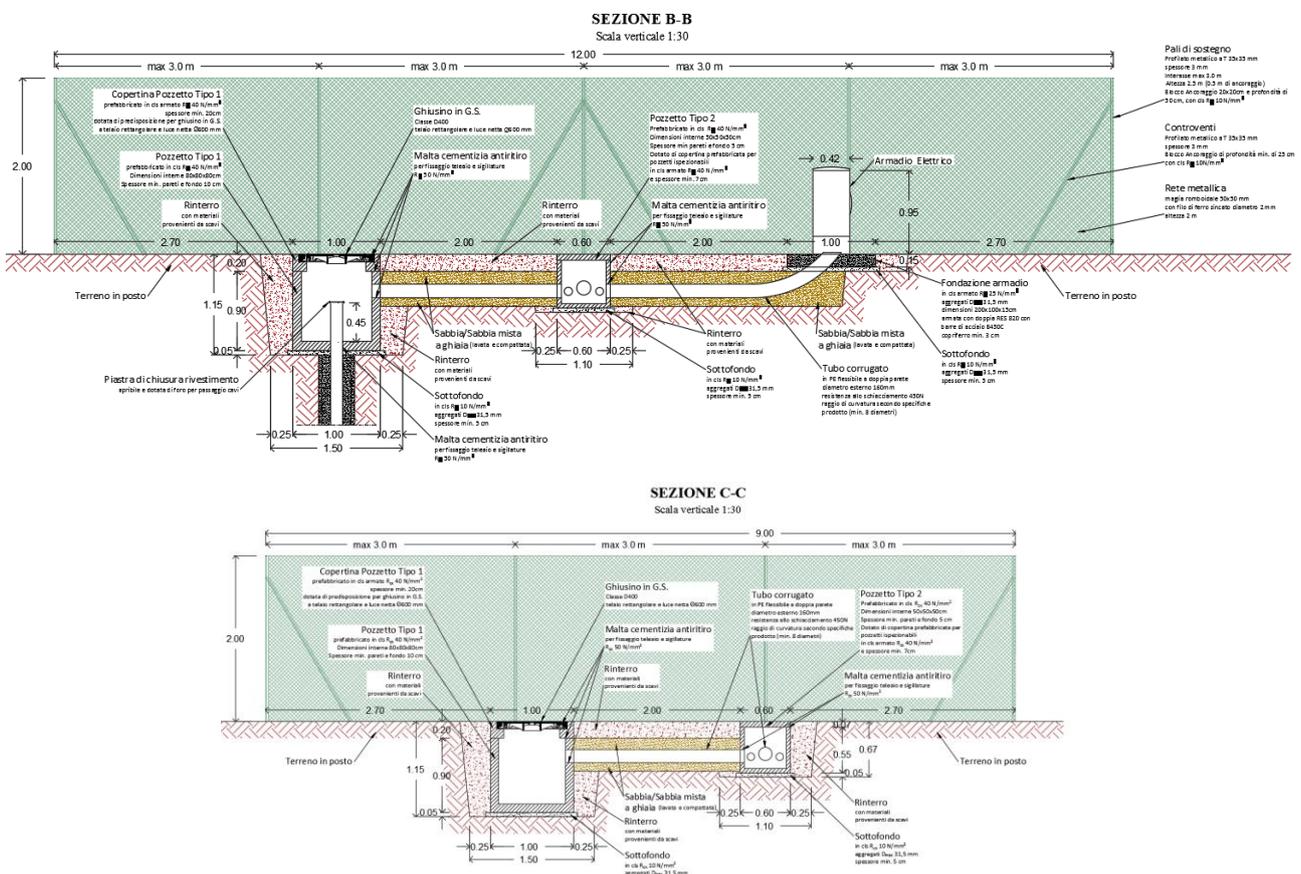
Opere superficiali, sezioni e dettagli (sezioni B-B e C-C, estratto ET_TAV09)
